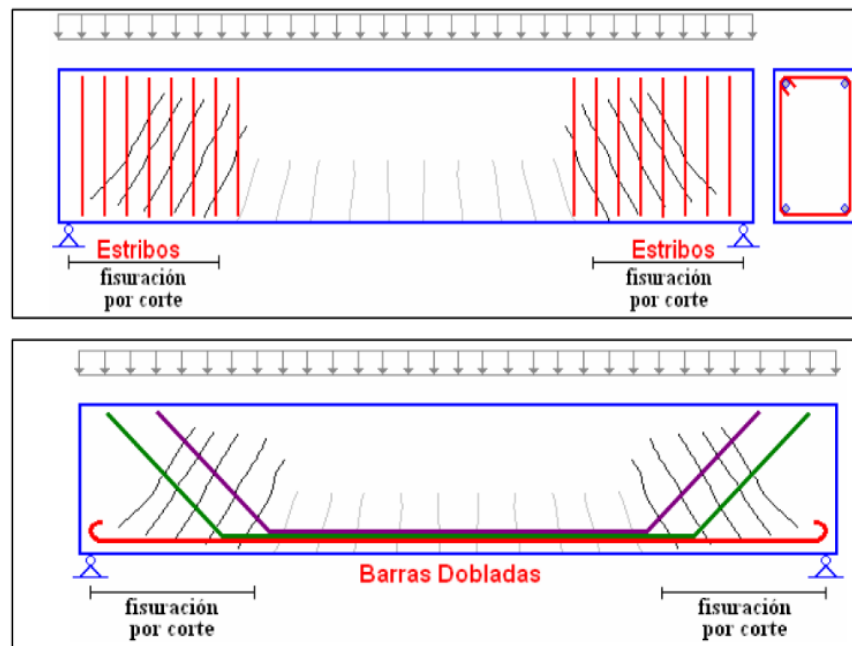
Armadura transversal y diagonal que cose a las fisuras de cortante.
